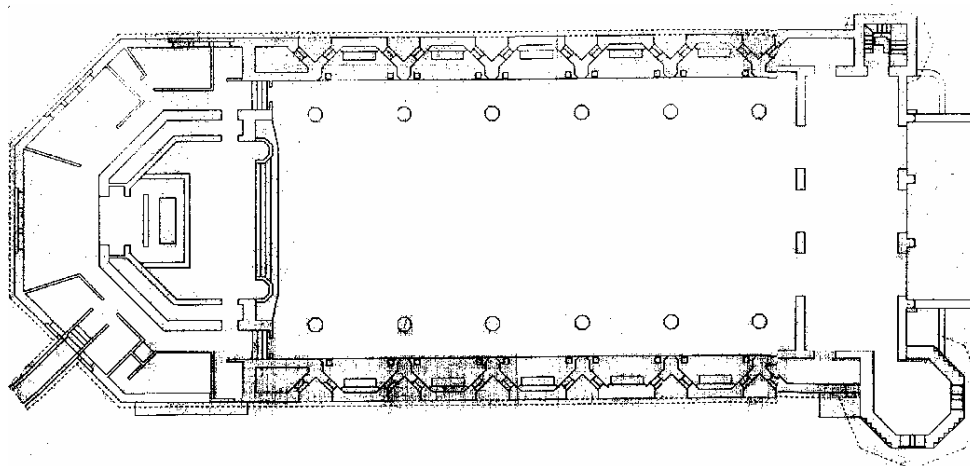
Planta da igreja de Nossa Senhora da Conceição (Porto) [3]
